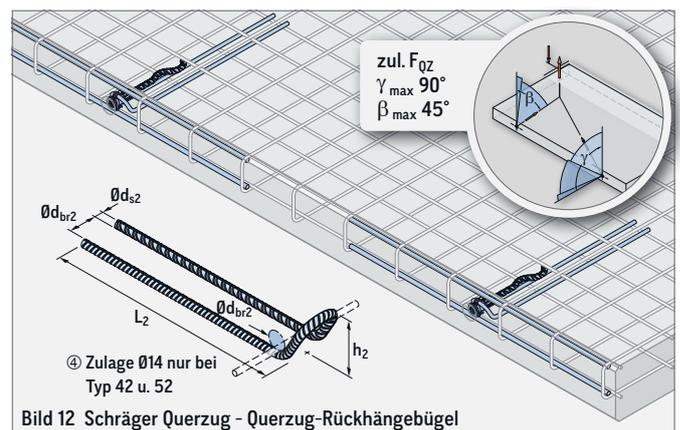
Schräger Querzug - Querzug-Rückhängebügel
